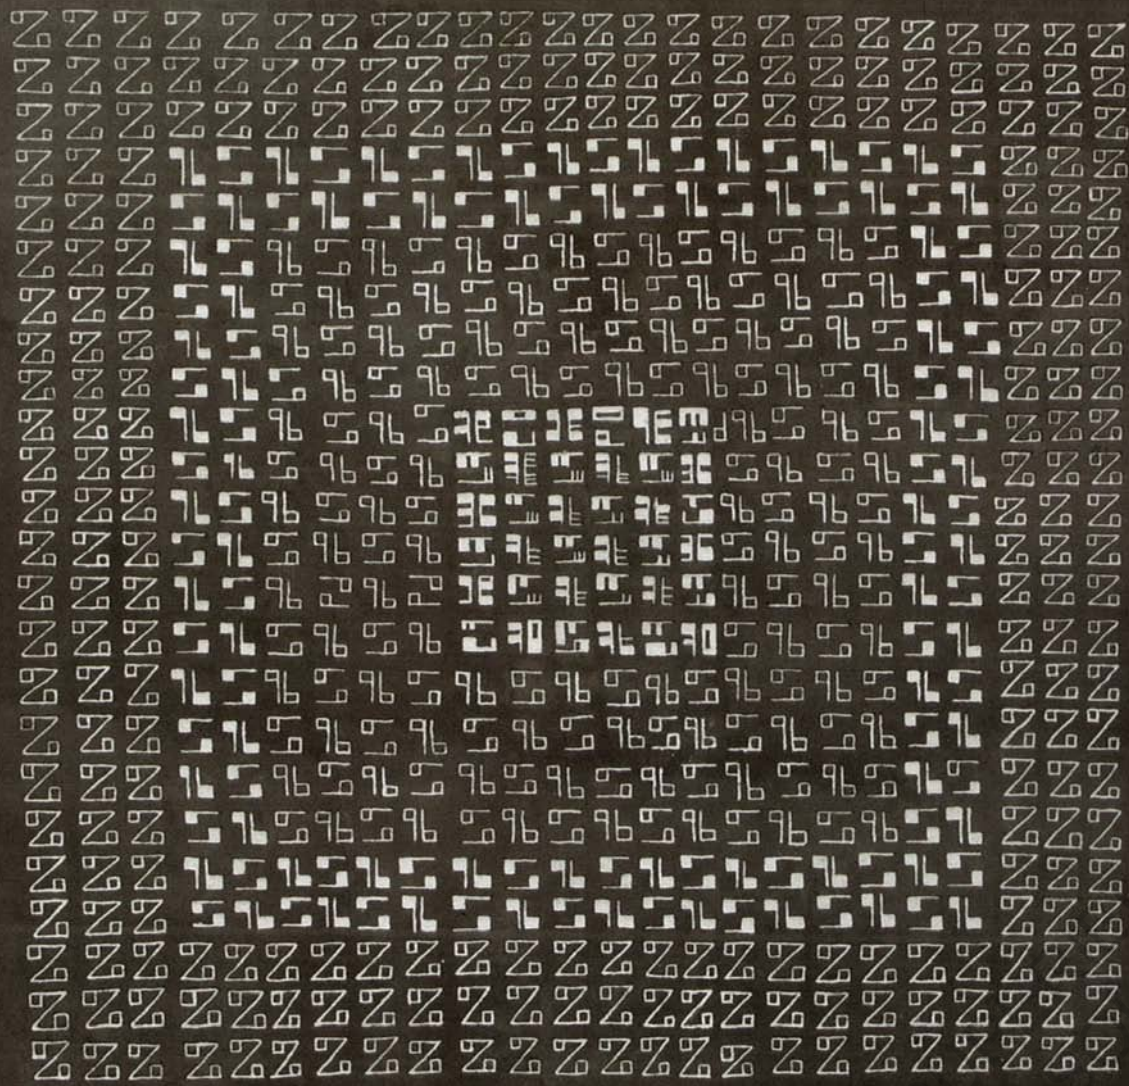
Enduit de terre blanche recouvert par un enduit de terre noire
